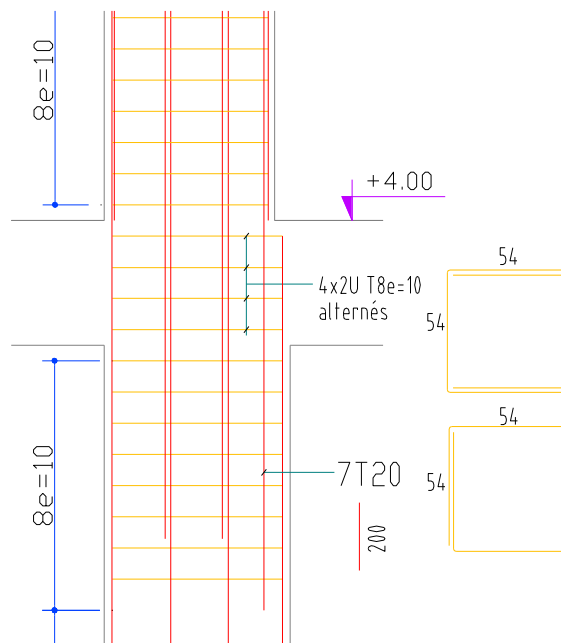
Ferrailage de recouvrement des poteaux $60 \times 60 \text{ cm}^2$ avec les poteaux $55 \times 55 \text{ cm}^2$.
